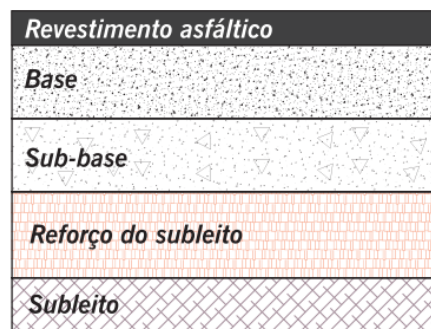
Perfil Tipo de um Pavimento Flexível
